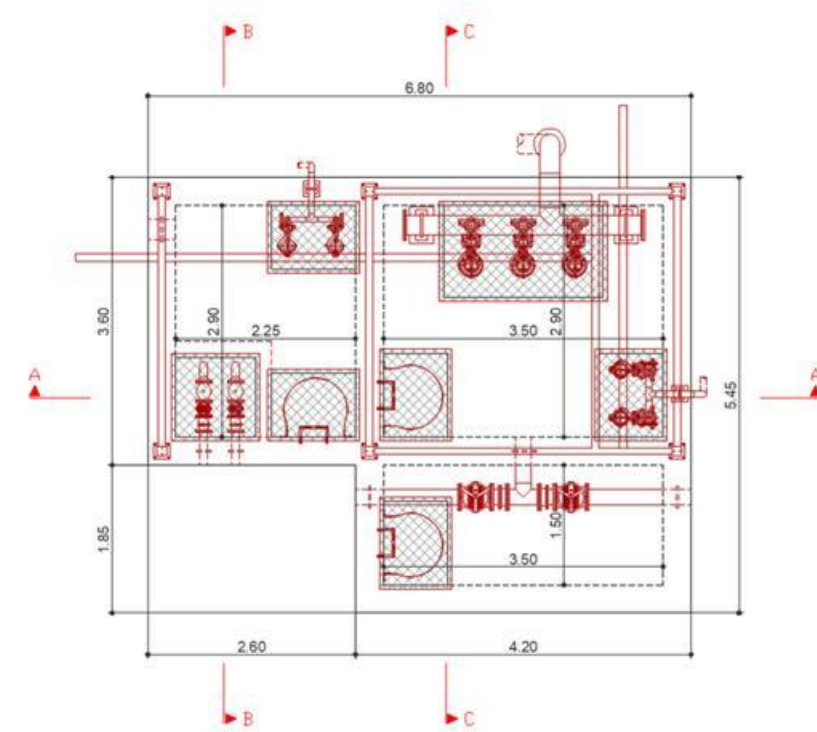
Planta de la arqueta de purga y recirculación de fangos
